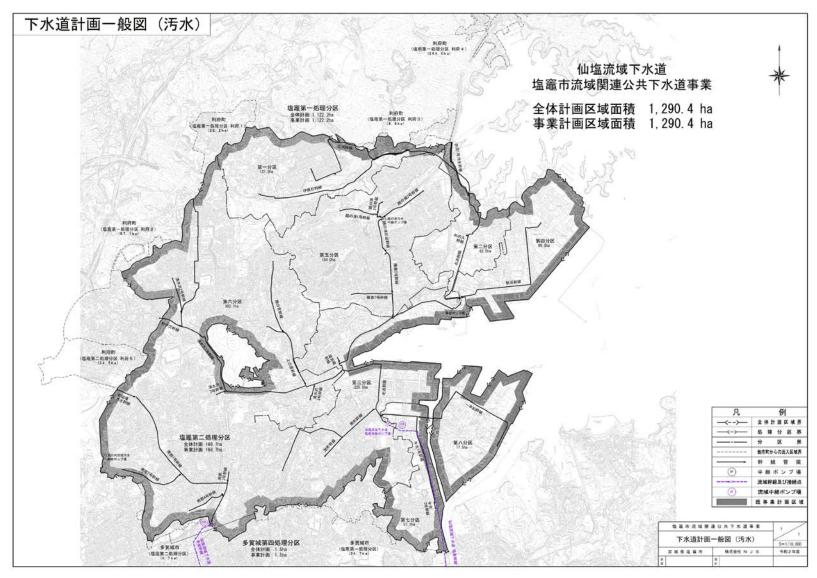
塩竈市下水道計画一般平面図 (汚水)
